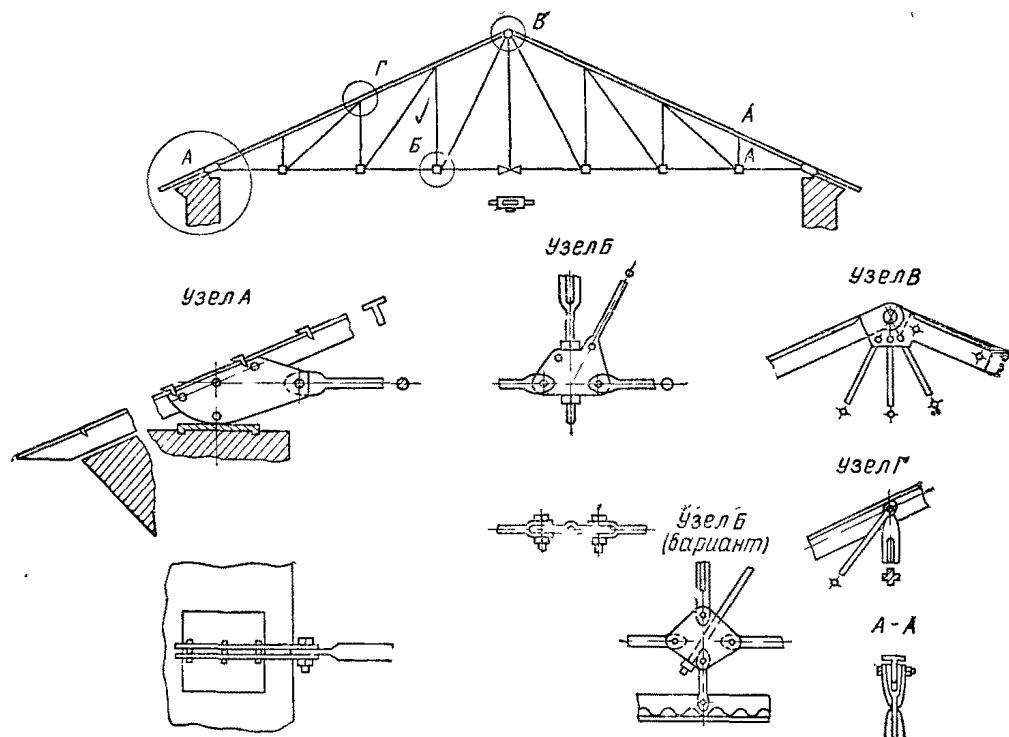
Стропильная ферма (70-е годы XIX в.)
